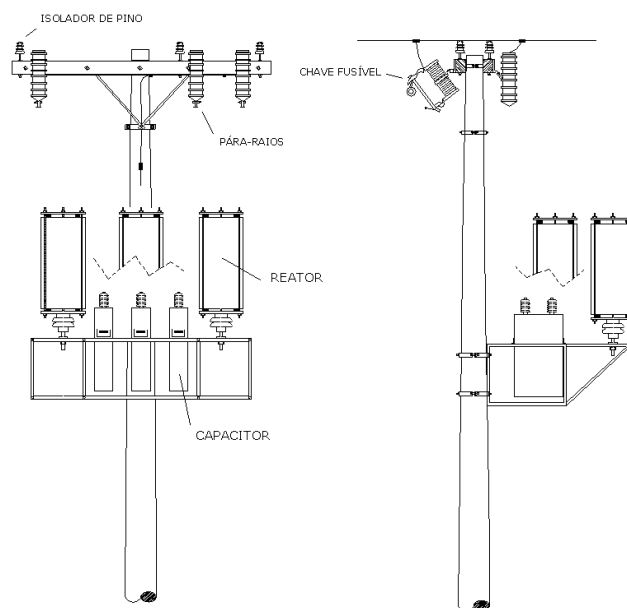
Desenho esquemático da estrutura construtiva do filtro.
